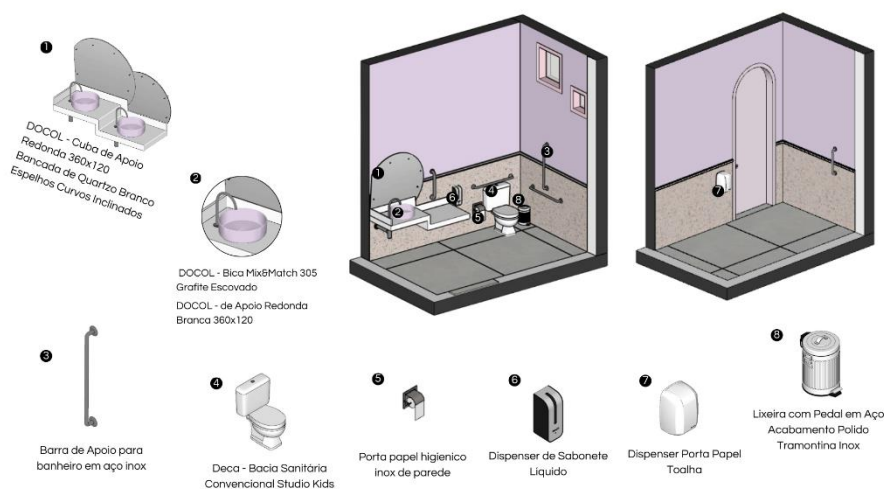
Banheiro Acessível: Vistas dos Acabamentos
